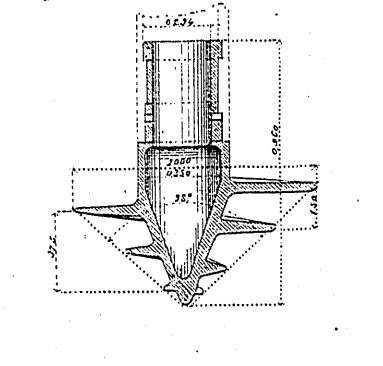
Corte vertical a un pilote de T.M.C.A.
